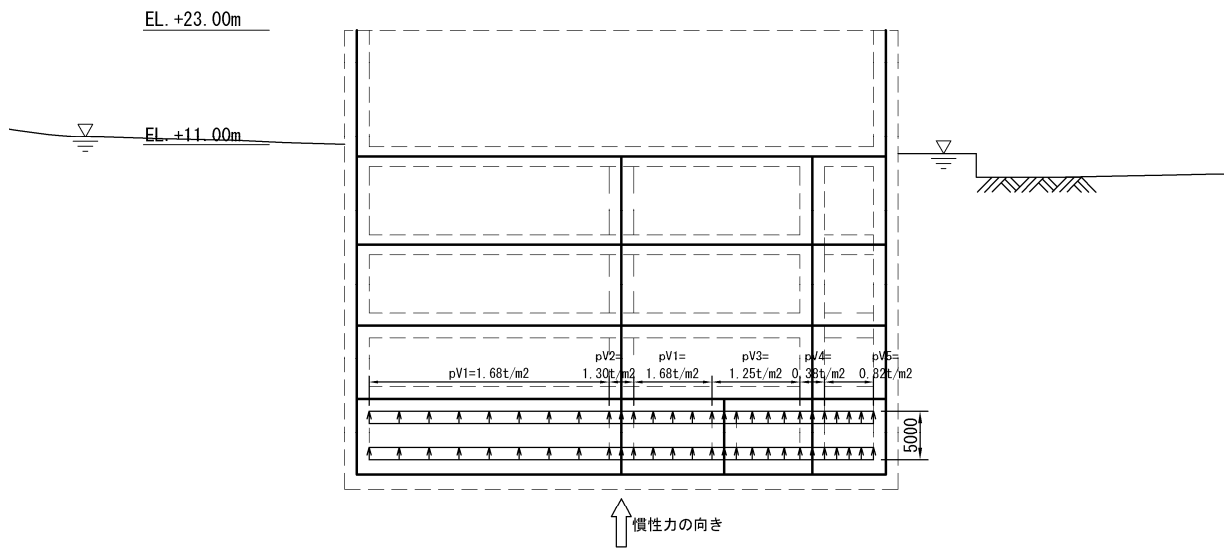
(4) 鉛直動による動水圧図 (東西方向断面)
